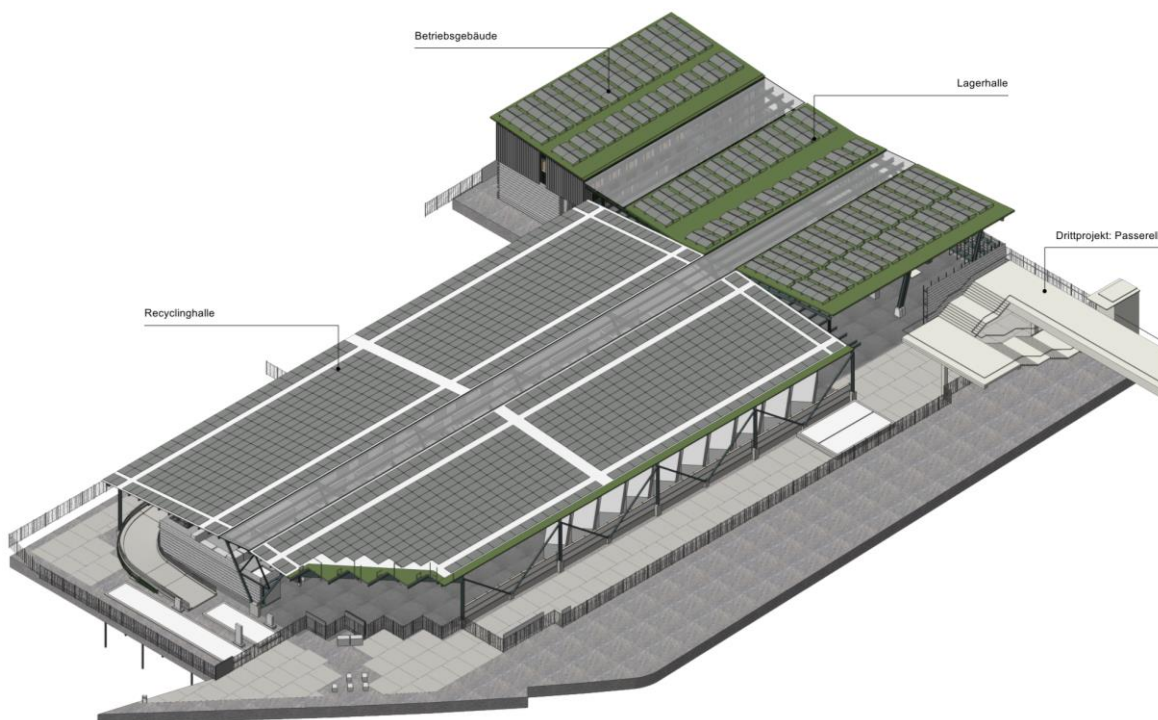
Axonometrie des geplanten Recyclingzentrums Juch-Areal mit Recyclinghalle, Betriebsgebäude, Lagerhalle
